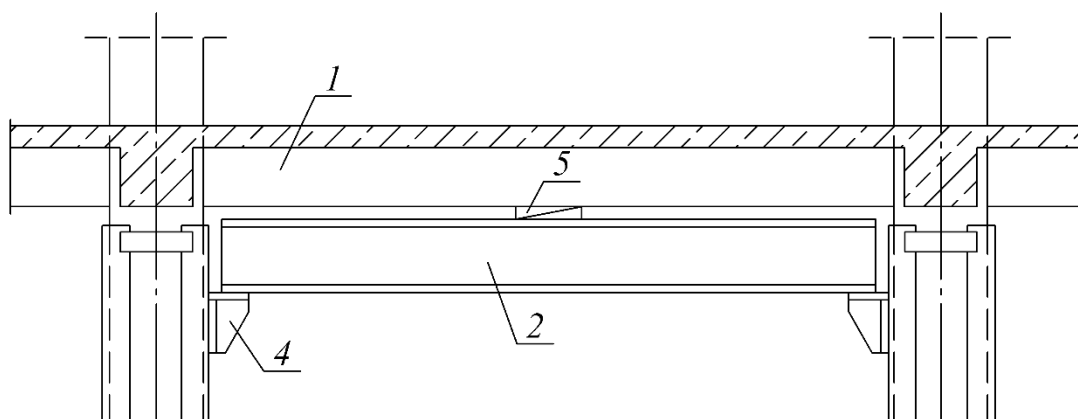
Усиление дополнительной упругой опорой (металлической балкой) на кронштейнах
